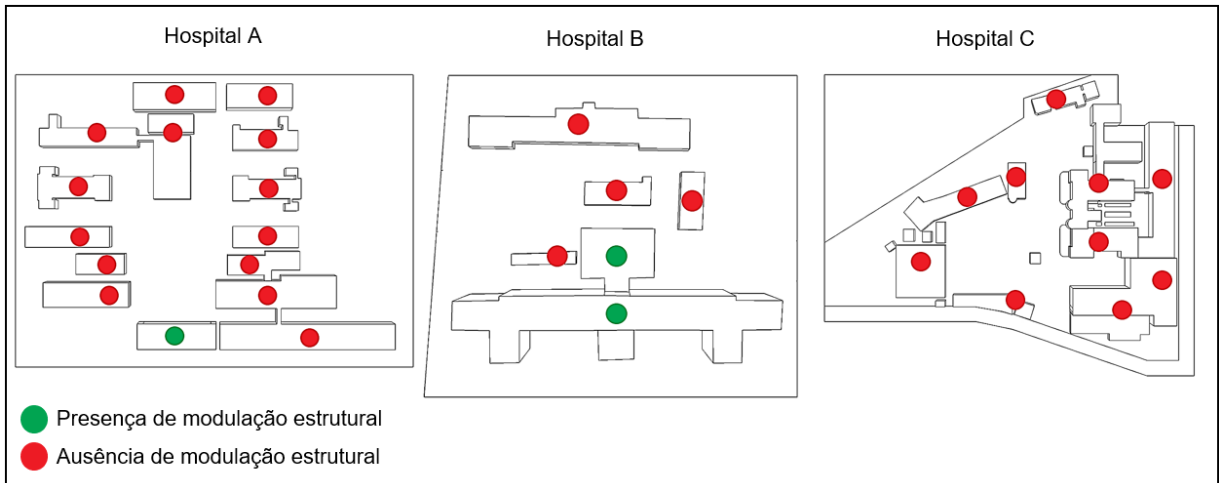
Croqui da planta baixa (sem escala) de cada edificação com identificação dos sistemas construtivos estruturais identificados
